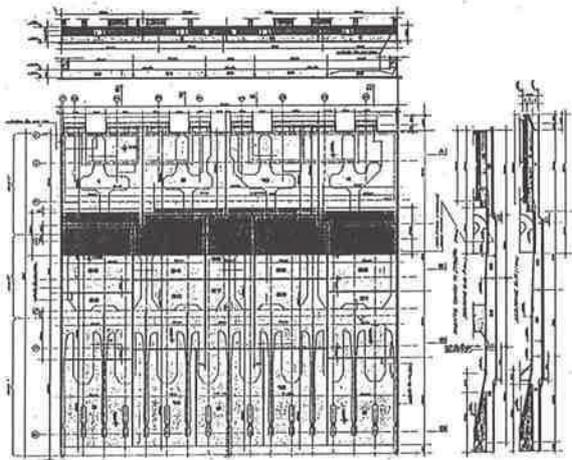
Suddivisione in conci di getto del mat di fondazione.
